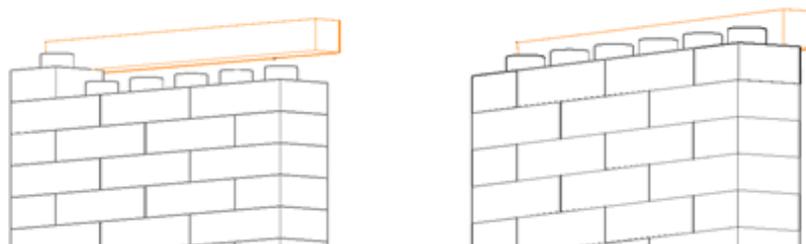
Encaje de la última hilada del muro con la solera instalada. Fuente: Elaboración propia (2016)
